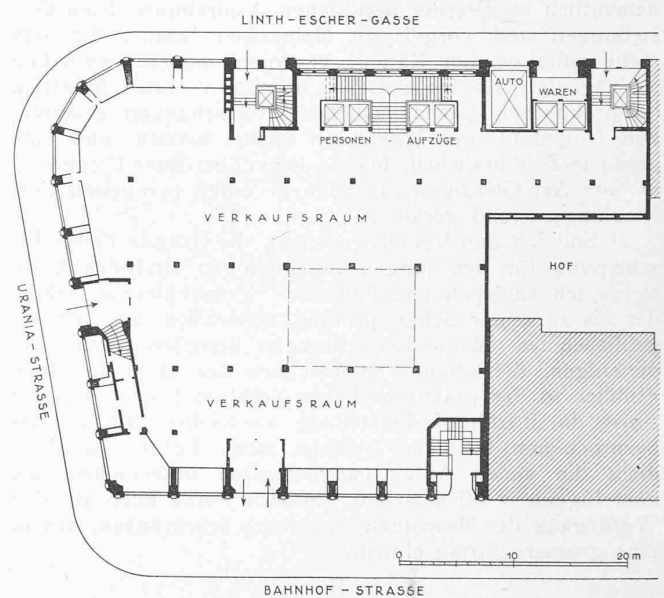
Grundriss vom Erdgeschoss im heutigen Vollausbau. — 1 : 600.
